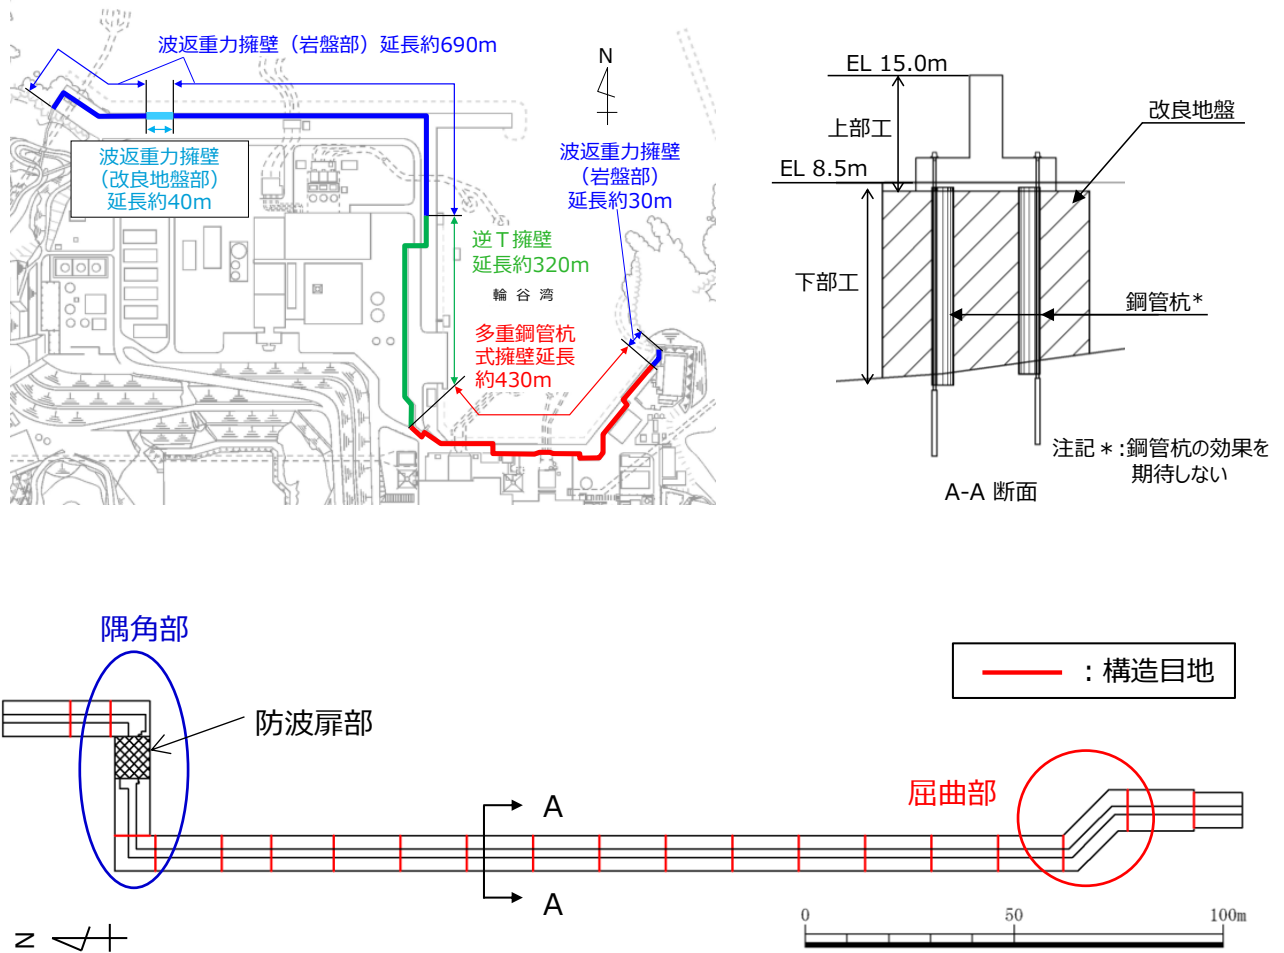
防波壁（逆T擁壁）の構造目地（平面図）
